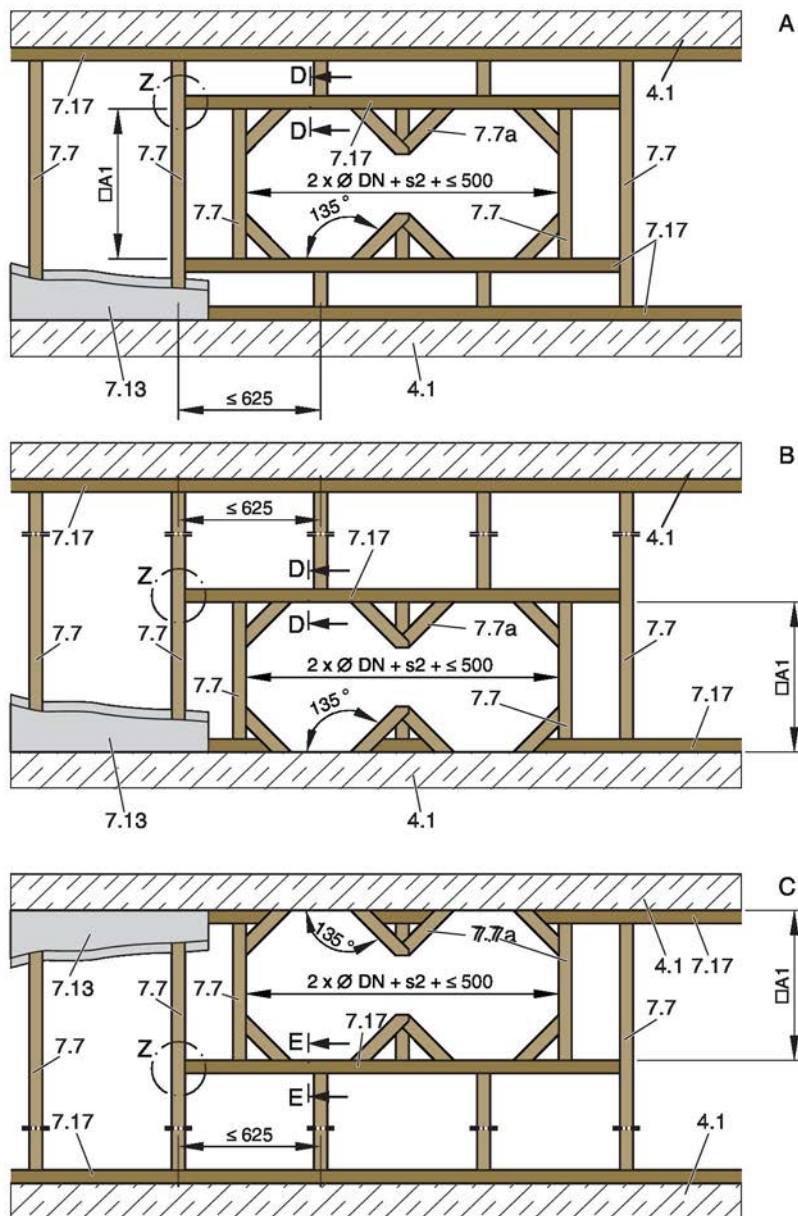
Perete despărțitor ușor cu structură de sprijin din lemn și placare pe ambele părți, flanșă la flanșă, dimensiuni nominale: Ø lățimea nominală 450 – 800
